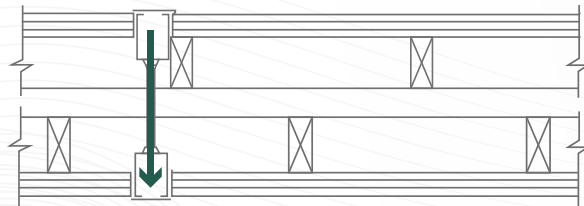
Ruido debido a cajas de registro entre muros separadores.
